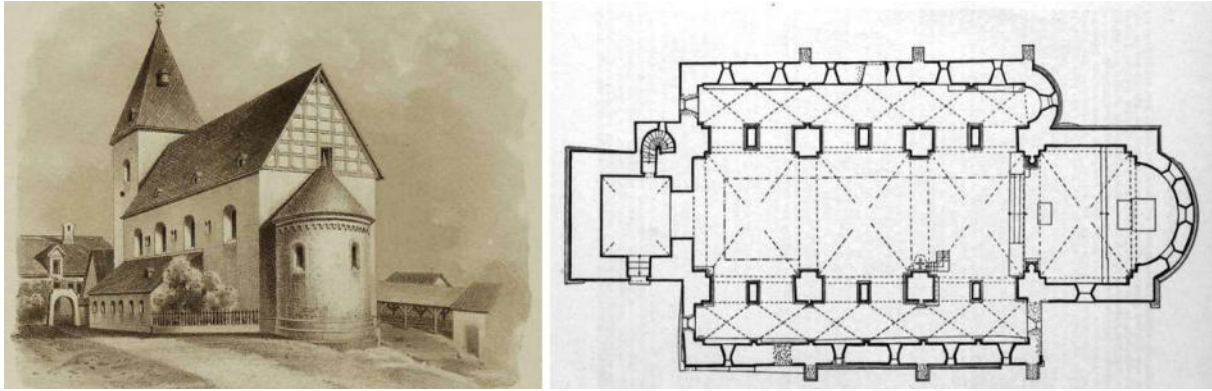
Kirche in Adorf – Zeichnung von August Orth vor 1849, Grundriss [1]
